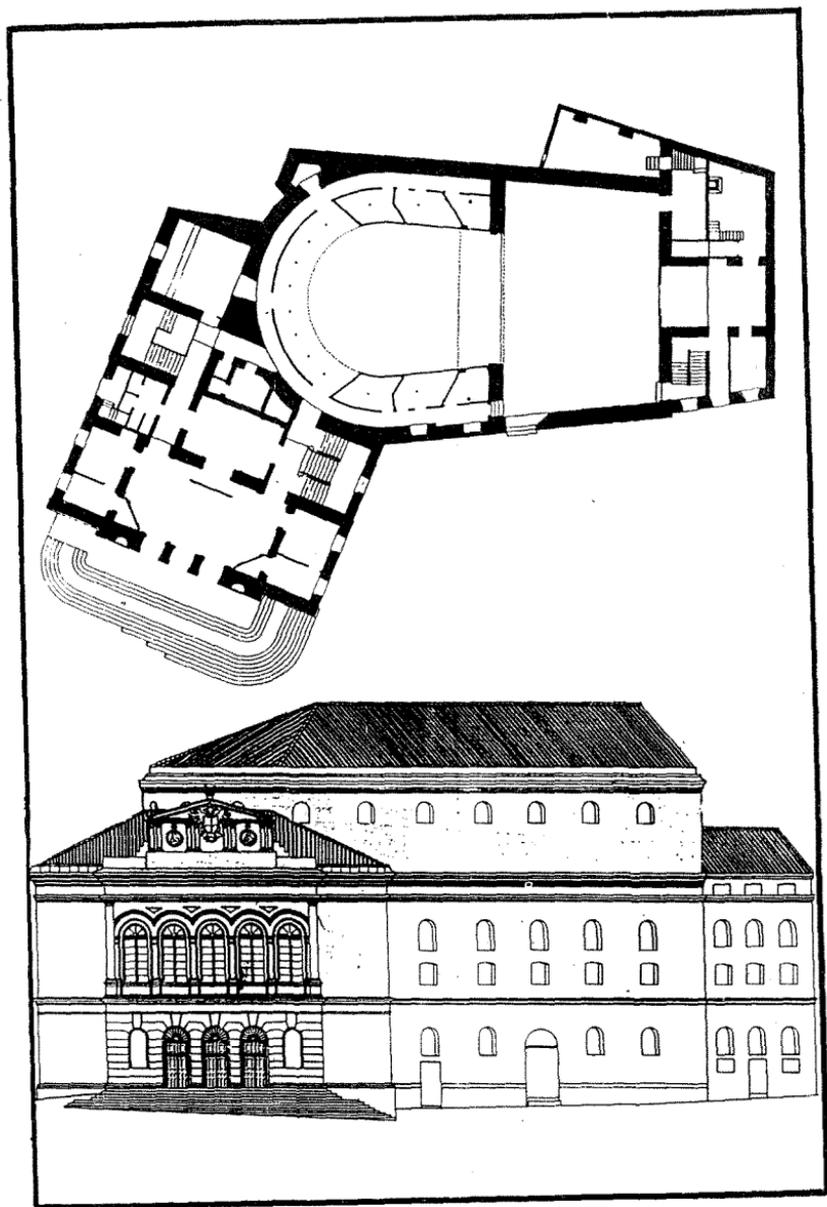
Planta general y alzado del Teatro en 1985. (Arquitectura teatral en España).
